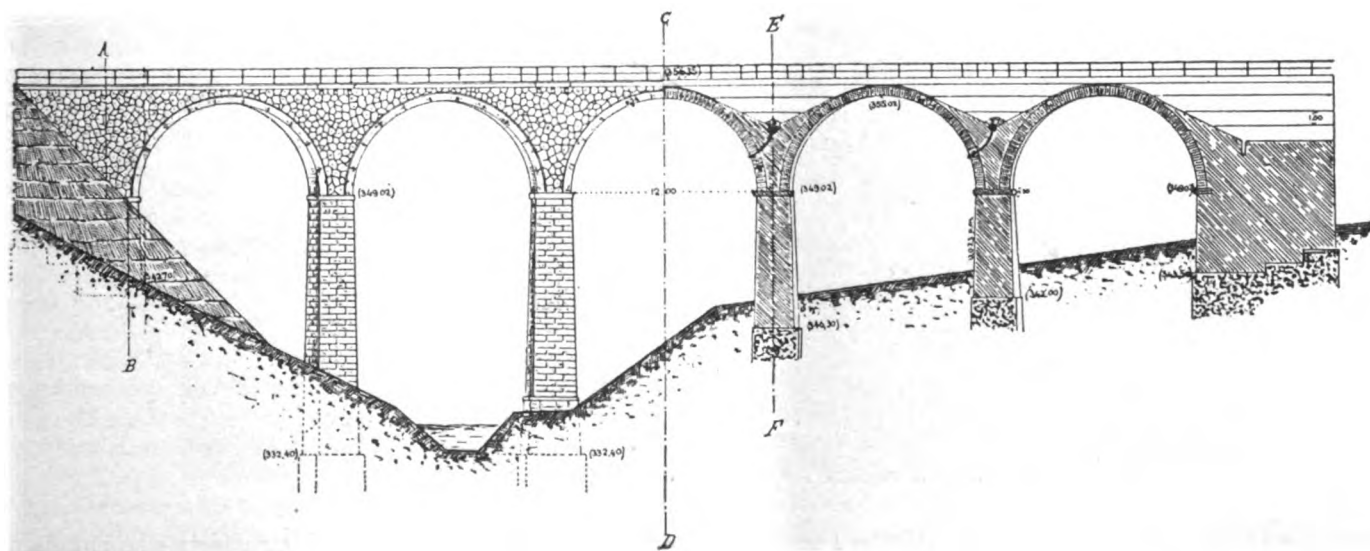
Viadotto della Selva. - Prospetto e sezione longitudinale.
